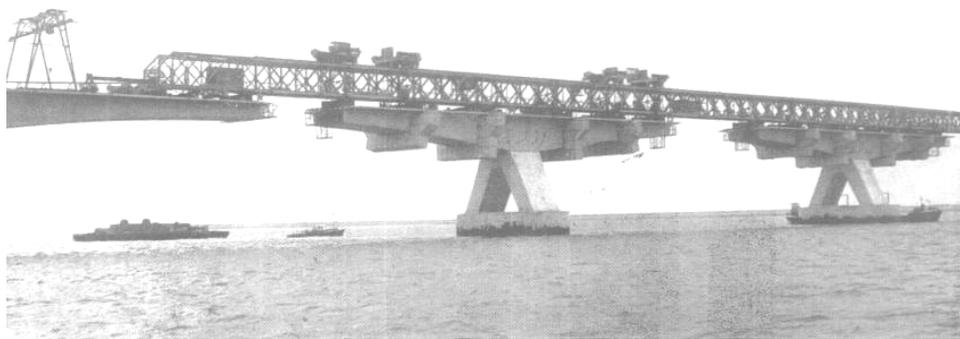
Construcción del Puente sobre el Escalda Oriental, Holanda.
